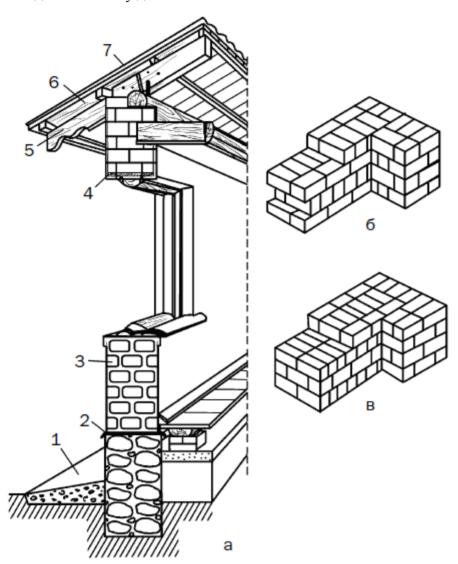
Конструкция саманной стены: а — в разрезе; б — кладка в 1 1/2 блока; в — кладка в 2 блока; 1 — отмостка; 2 — слой гидроизоляции; 3 — кладка; 4 — перемычка; 5 — кобылка; 6 — дощатая подшивка; 7 — кровля
